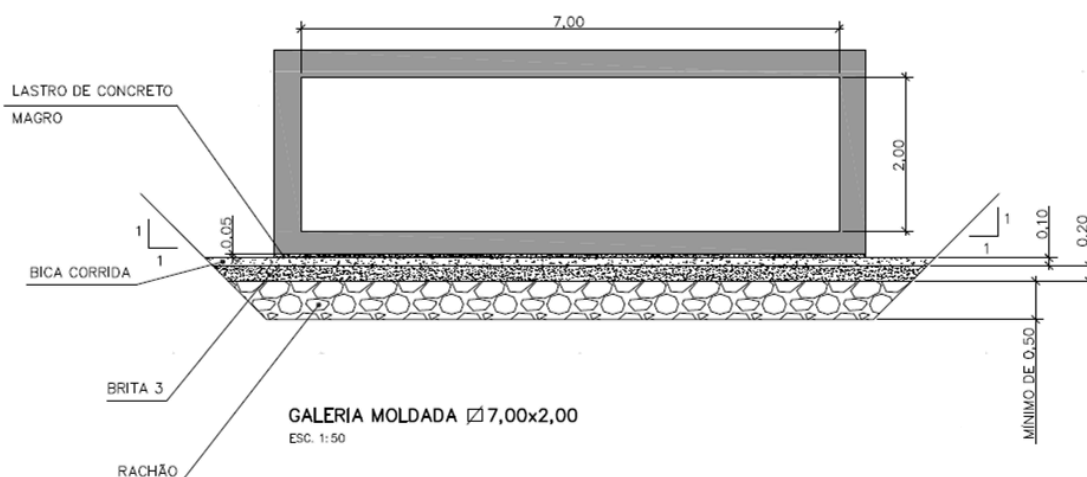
Seção transversal da galeria de canalização em concreto existente
